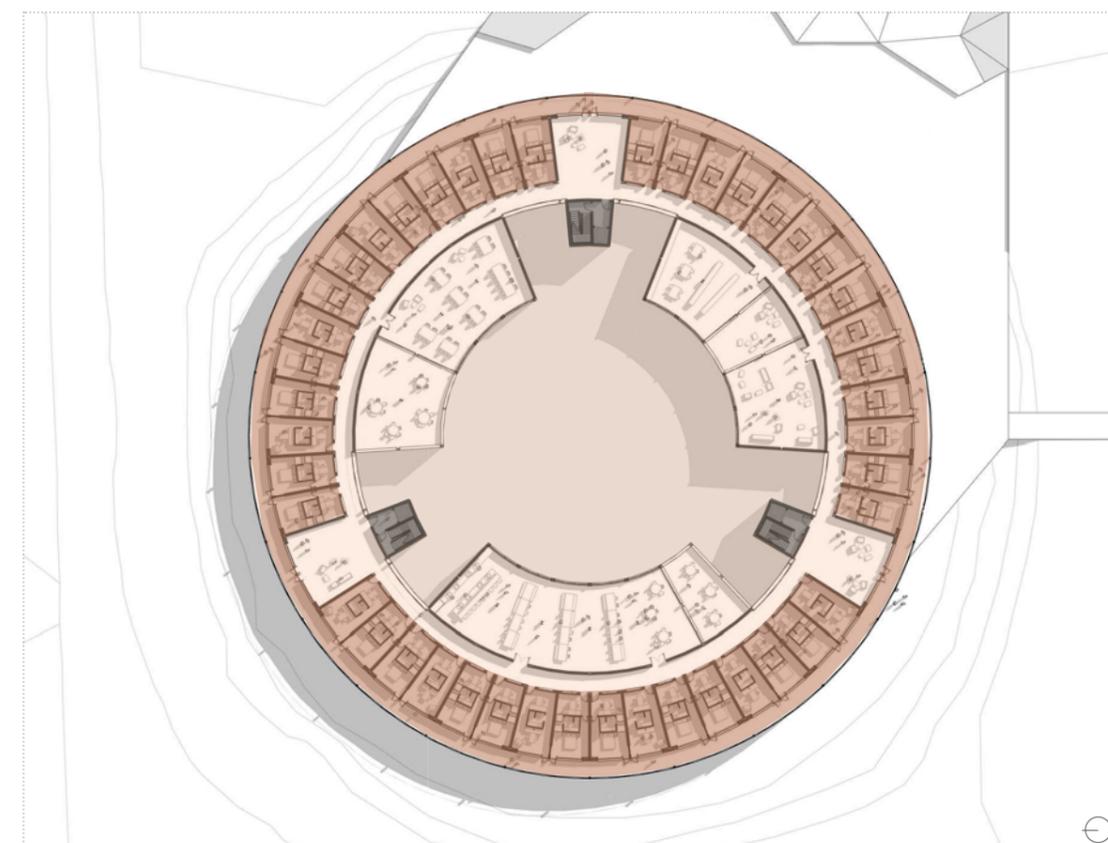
| Planta de divisão do espaço privado e coletivo, (Silo B), Escala 1:800
